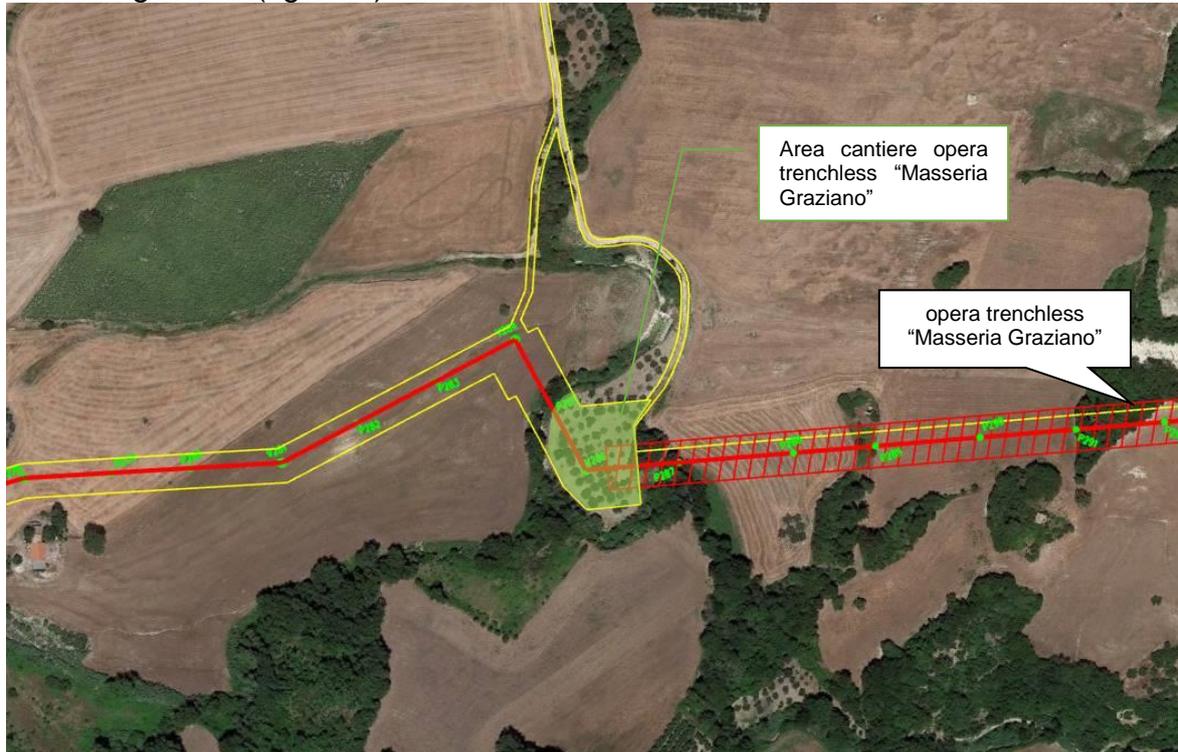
Stralcio satellitare con tracciato di progetto ed individuazione dell'area di cantiere opera trenchless "Masseria Graziano"
